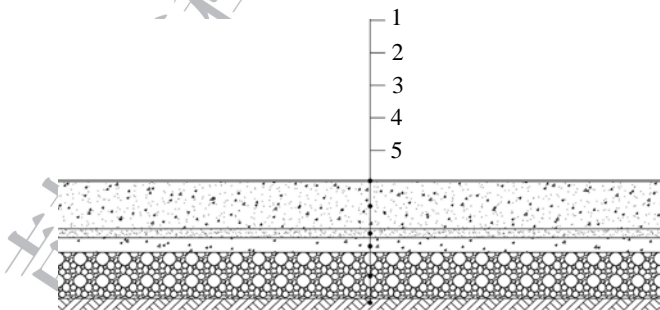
多孔隙透水混凝土路面结构层示意图
